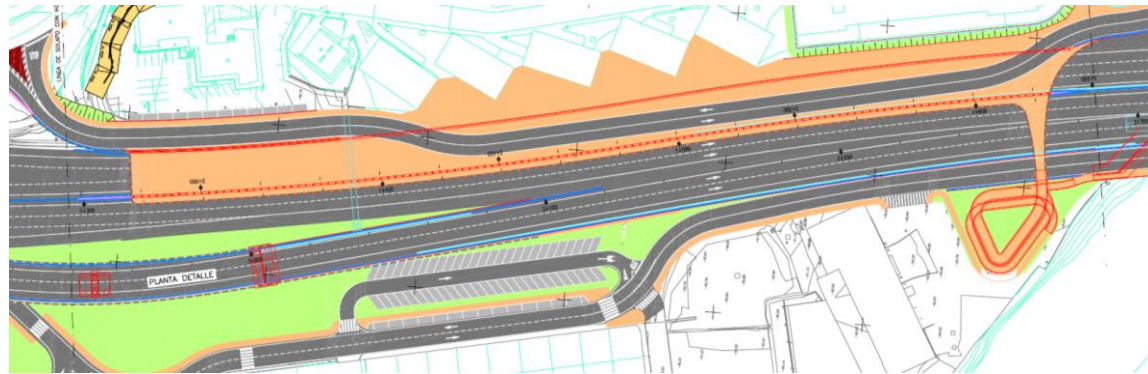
Aspecto en planta del Proyecto en la zona de Mimendi
